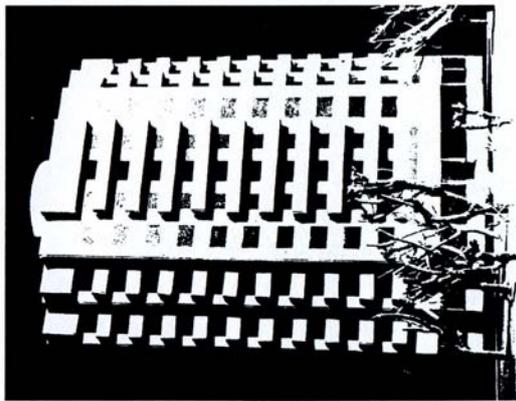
Проект 12-этажного жилого дома, возводимый подъемом перекрытий в г. Алматы с ядром жесткости. Колонны без ригелей удерживаются перекрытиями и могут расставляться свободно с одним необходимым условием – наибольшее расстояние между ними не должно превышать 9 метров, в том числе и по диагонали. Всю систему удерживает ядро жесткости. Вариант конструктивного решения удобен в стесненных условиях строительства
